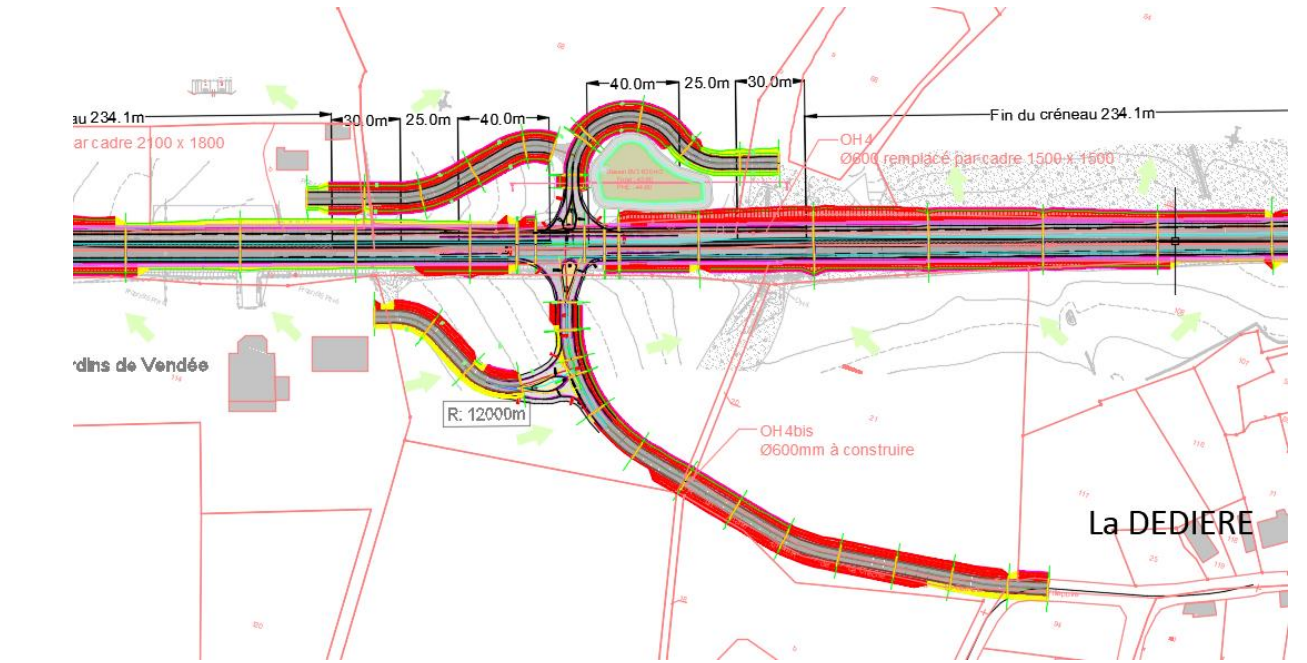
Plan du carrefour de la Dédrière - Section 1
